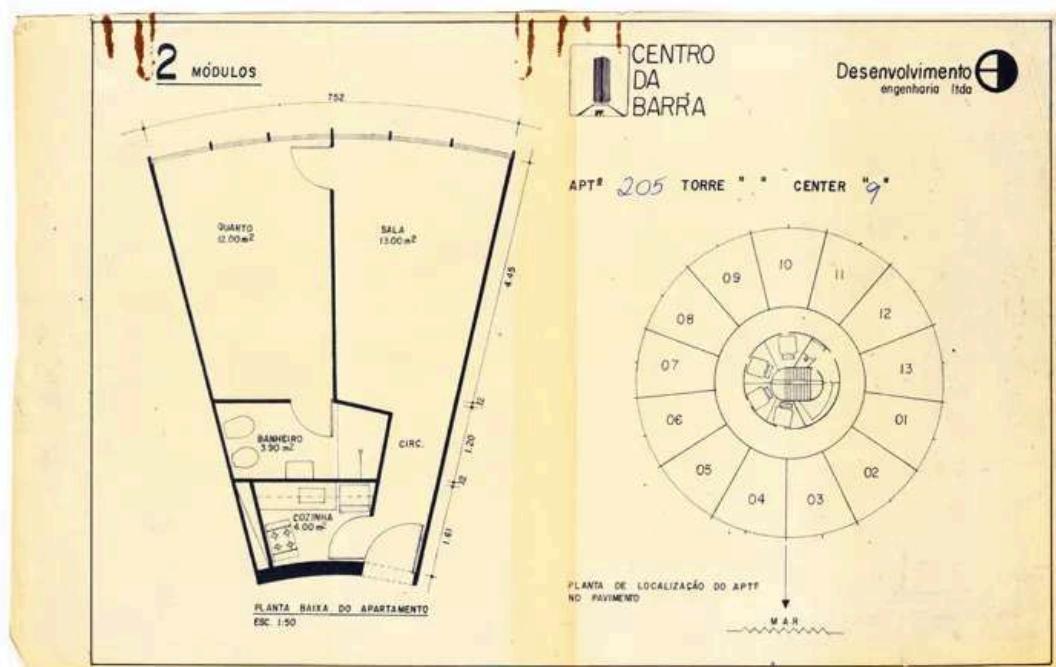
Oscar Niemeyer. Planta baixa do apartamento e planta de localização do apartamento no pavimento da Torre Charles de Gaulle. Rio de Janeiro, 1969.
